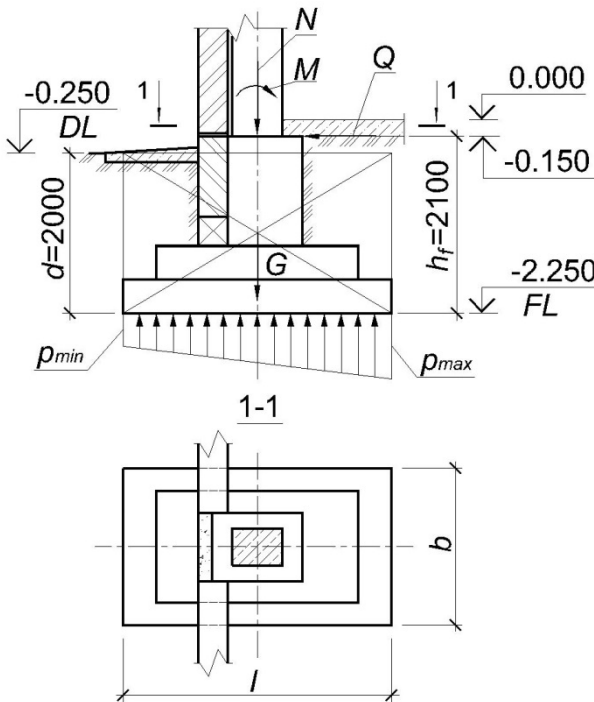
Схема к определению размеров подошвы фундамента под колонну промышленного здания (пример 4.4)
